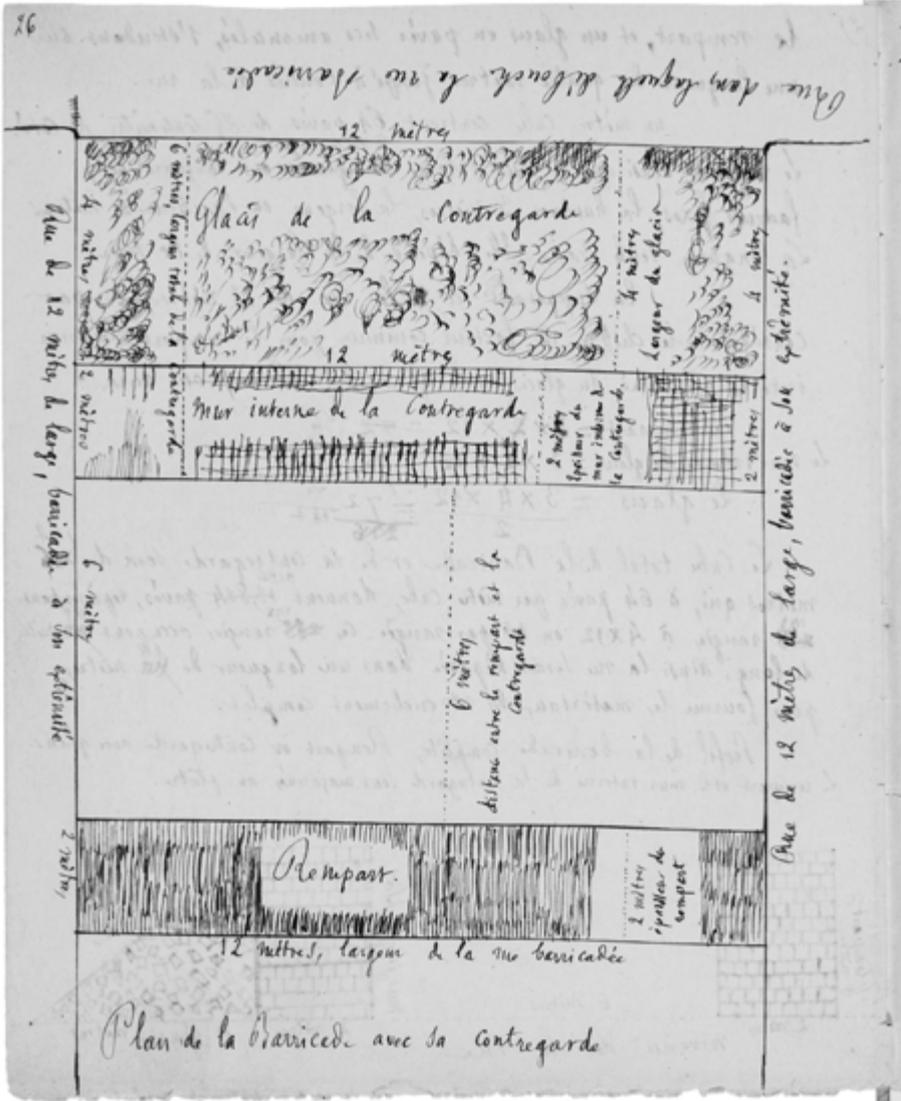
Plan der Barrikade mit ihrem Vorwall.
